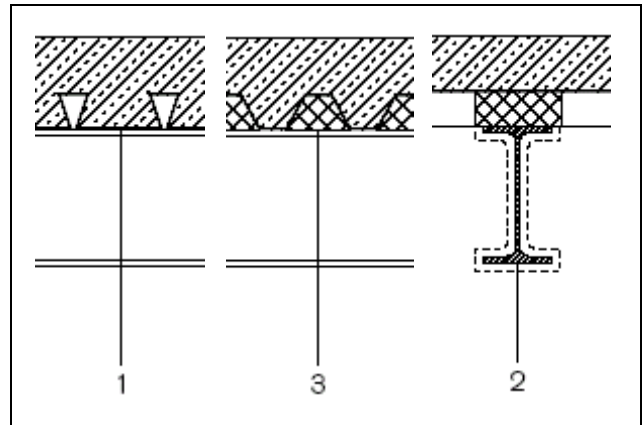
ungeschützt bleibende Flanschoberflächen (nur bei hinterschnittenen Profilblechen erlaubt)
